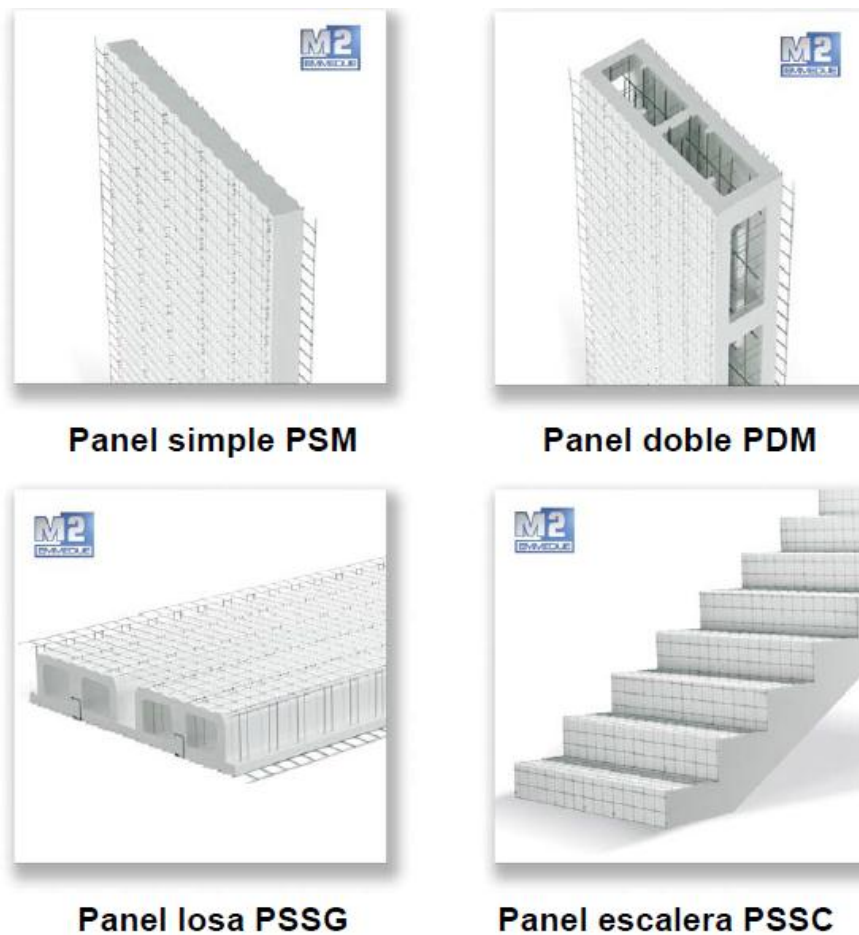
Tipos de paneles. Fuente: Emmedue. (2008). Sistema constructivo Emmedue: Módulo constructivo. Recuperado de: <http://www.mdue.it>
